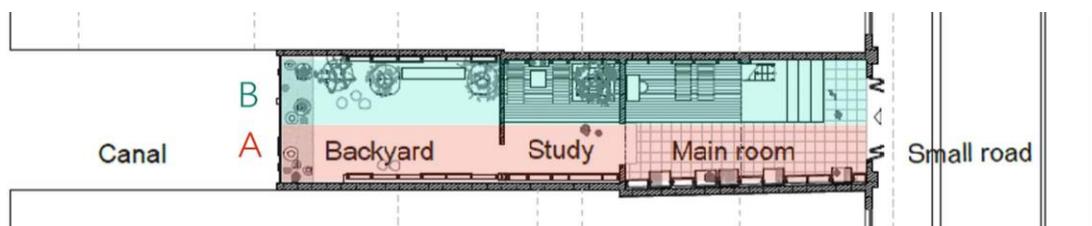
PLANTA MIN BURI OLD MARKET LIBRARY
